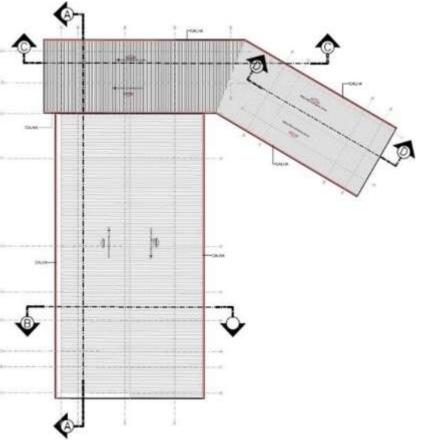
Planta de Cobertura – s/escala Fonte: autora, 2020.
